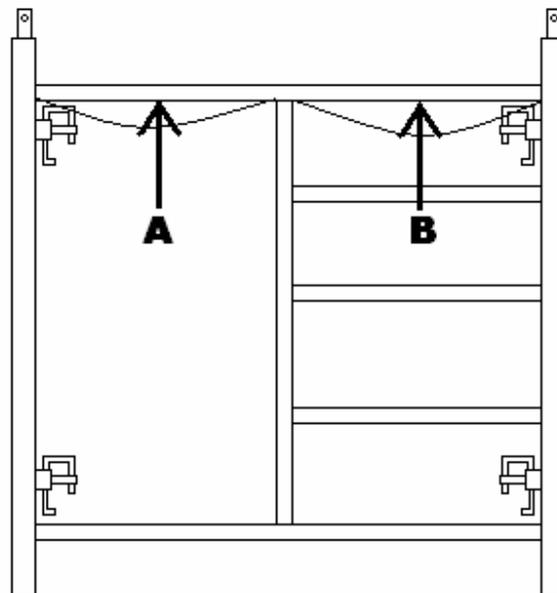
Dimensiones del marco del andamio para el primer ensayo
